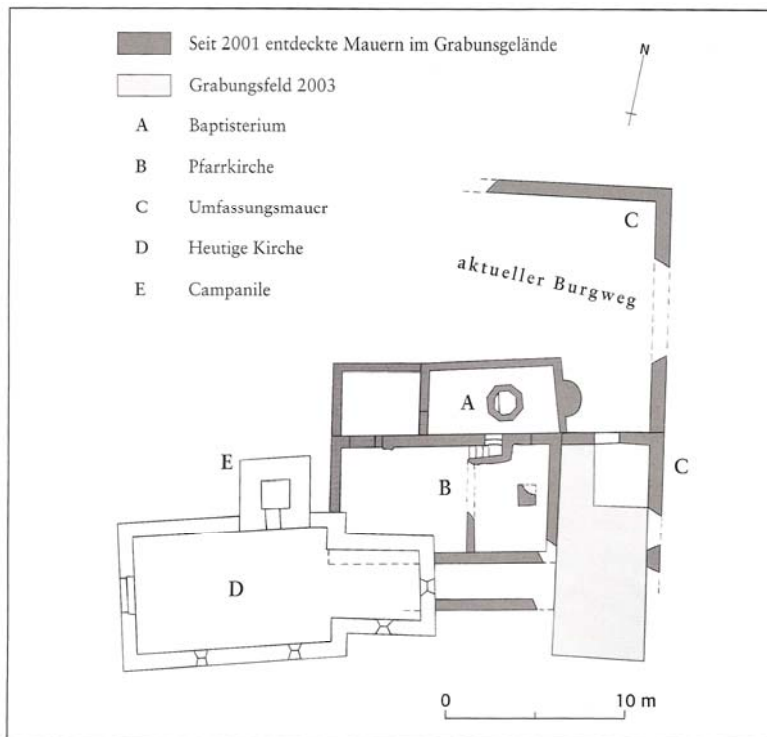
Sils i.D., Burganlage Hohenrätien. Grundrissplan. Mst. 1:400.
